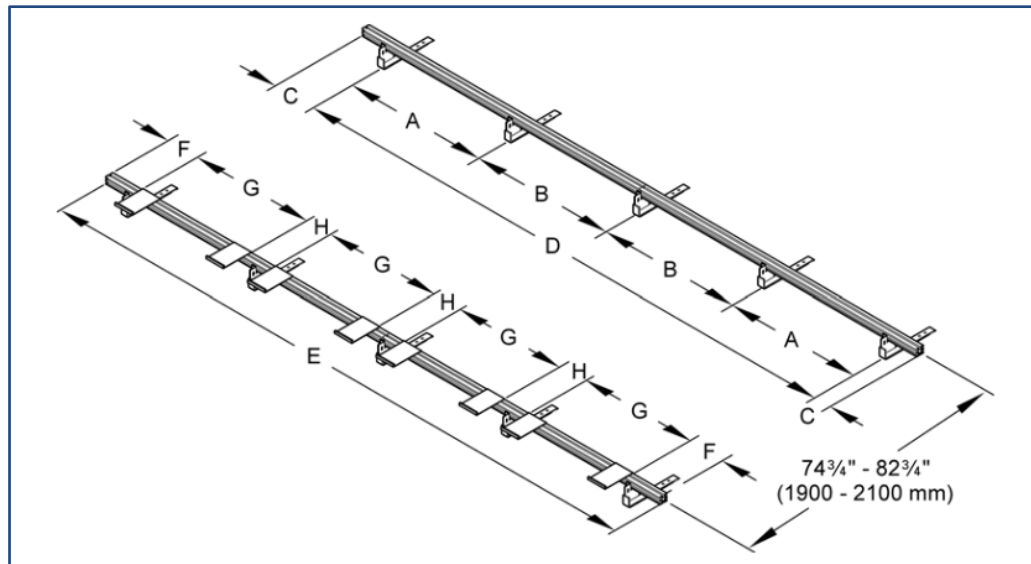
Configuración del fabricante para montaje de colectores planos en vertical en cubierta inclinada
